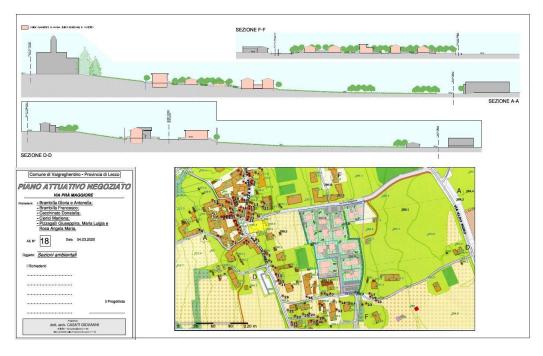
Sezioni per la valutazione di impatto degli alzati sul contesto
